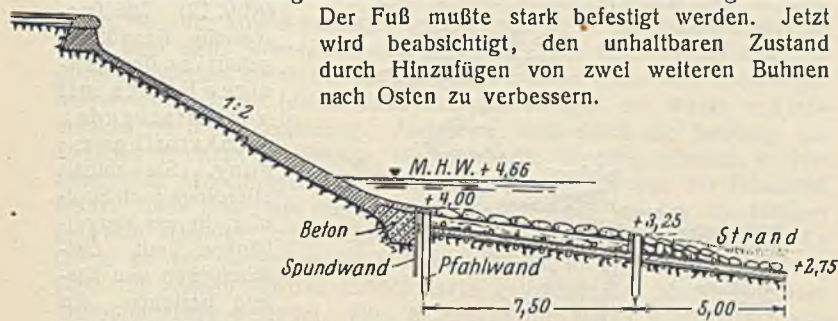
Schräges Deckwerk vor Mittelkerke. etwa 1:265.
